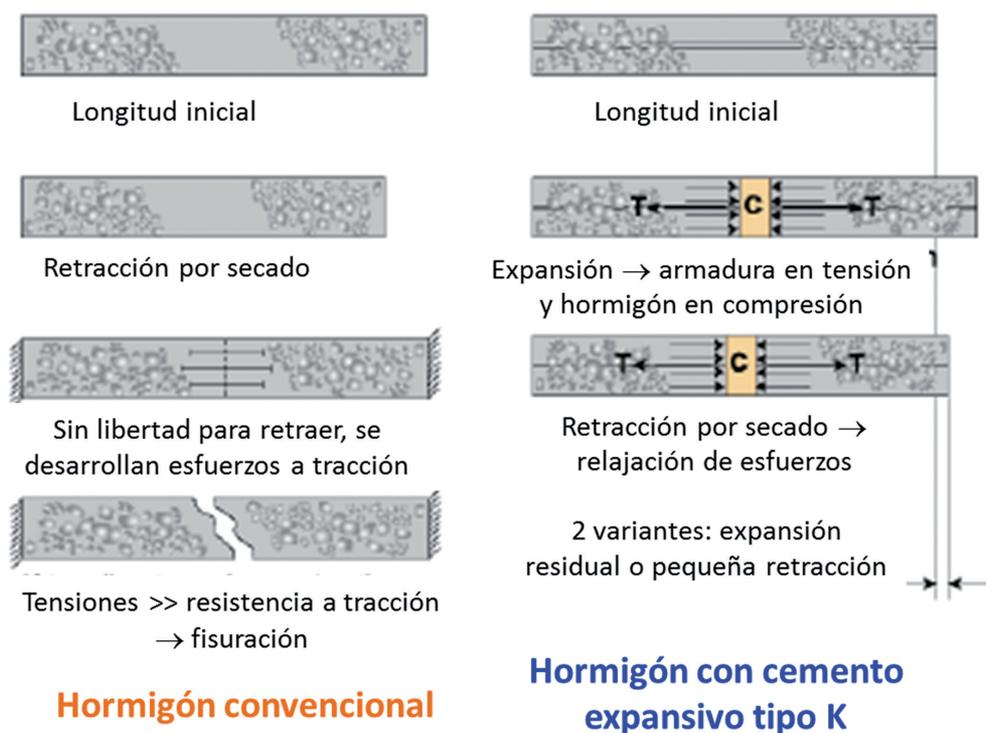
Muestra del comportamiento resistente de hormigones convencionales y hormigones con cemento o agente expansivo tipo K a la fisuración por retracción por secado (3).
